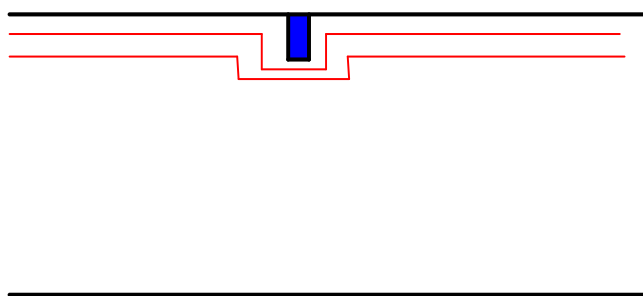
Restringimento dei canali per lo scavalco di travi a taglio
